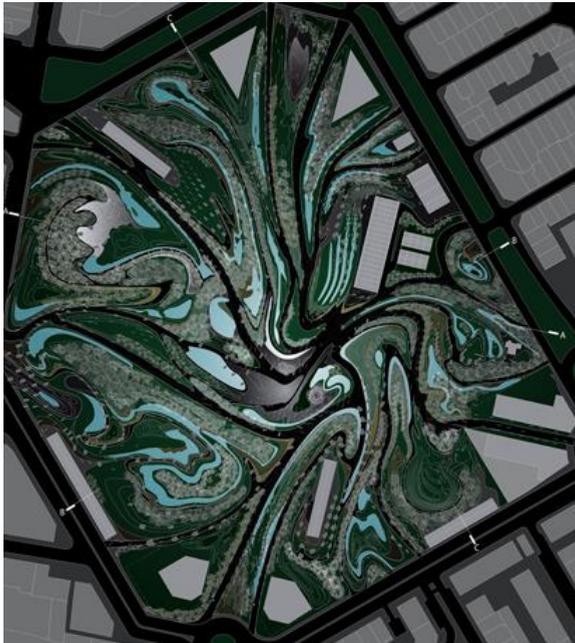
Planta Propuesta equipo 2. 8 (PAISEA, 2011)
